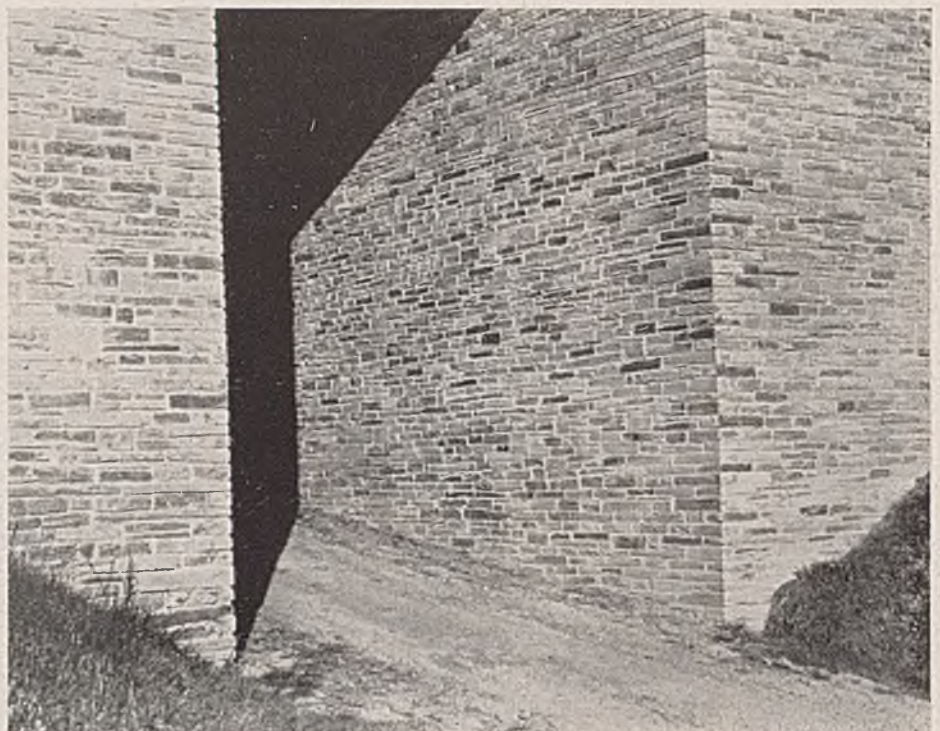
Wirtschaftswegeunterführung bei Plauen. Einzelheiten des hammerrechten Bruchsteinmauerwerks.
